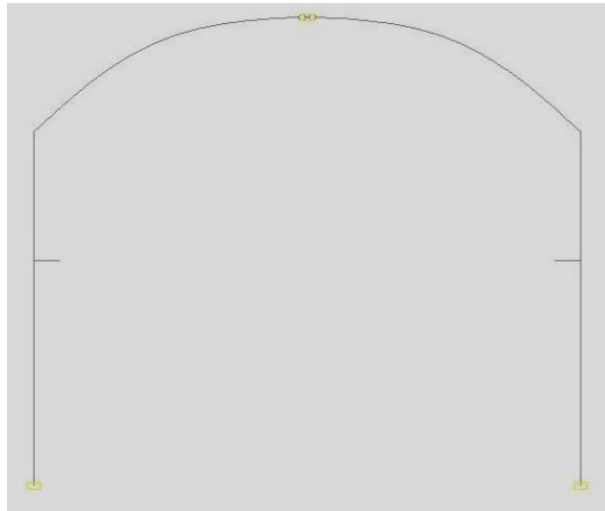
Расчетная схема железобетонной монолитной сводчатой рамы
